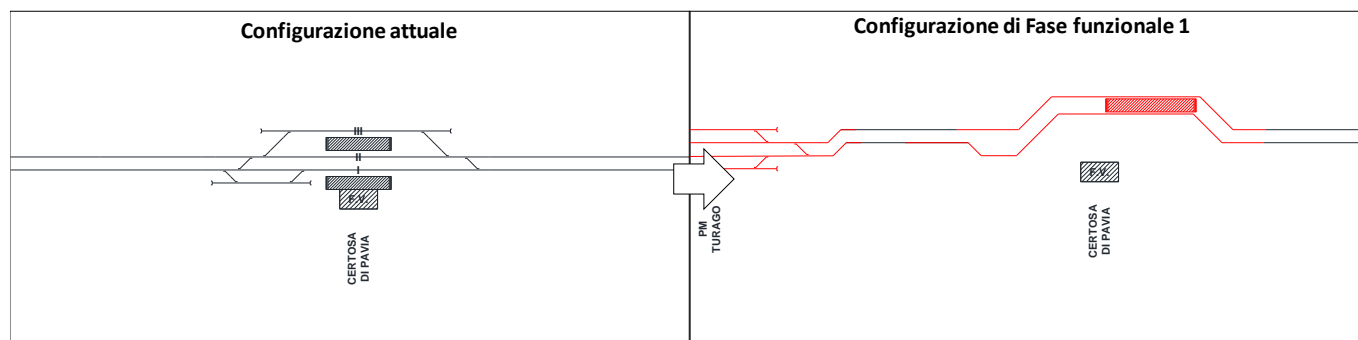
Configurazione attuale e futura (Fase 1) di Certosa di Pavia
